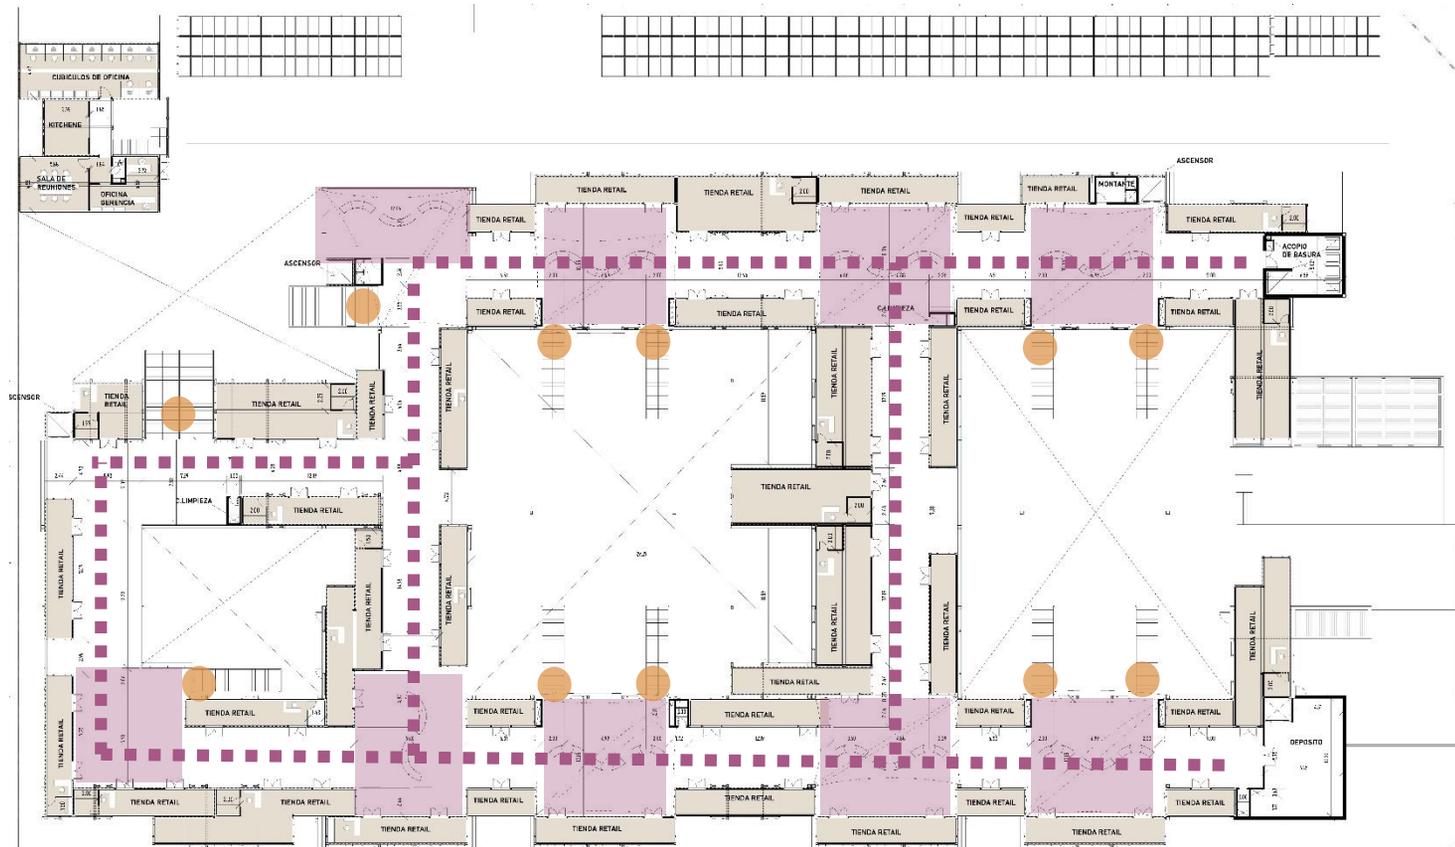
Plano de Segunda Planta. Fuente: Propia.
